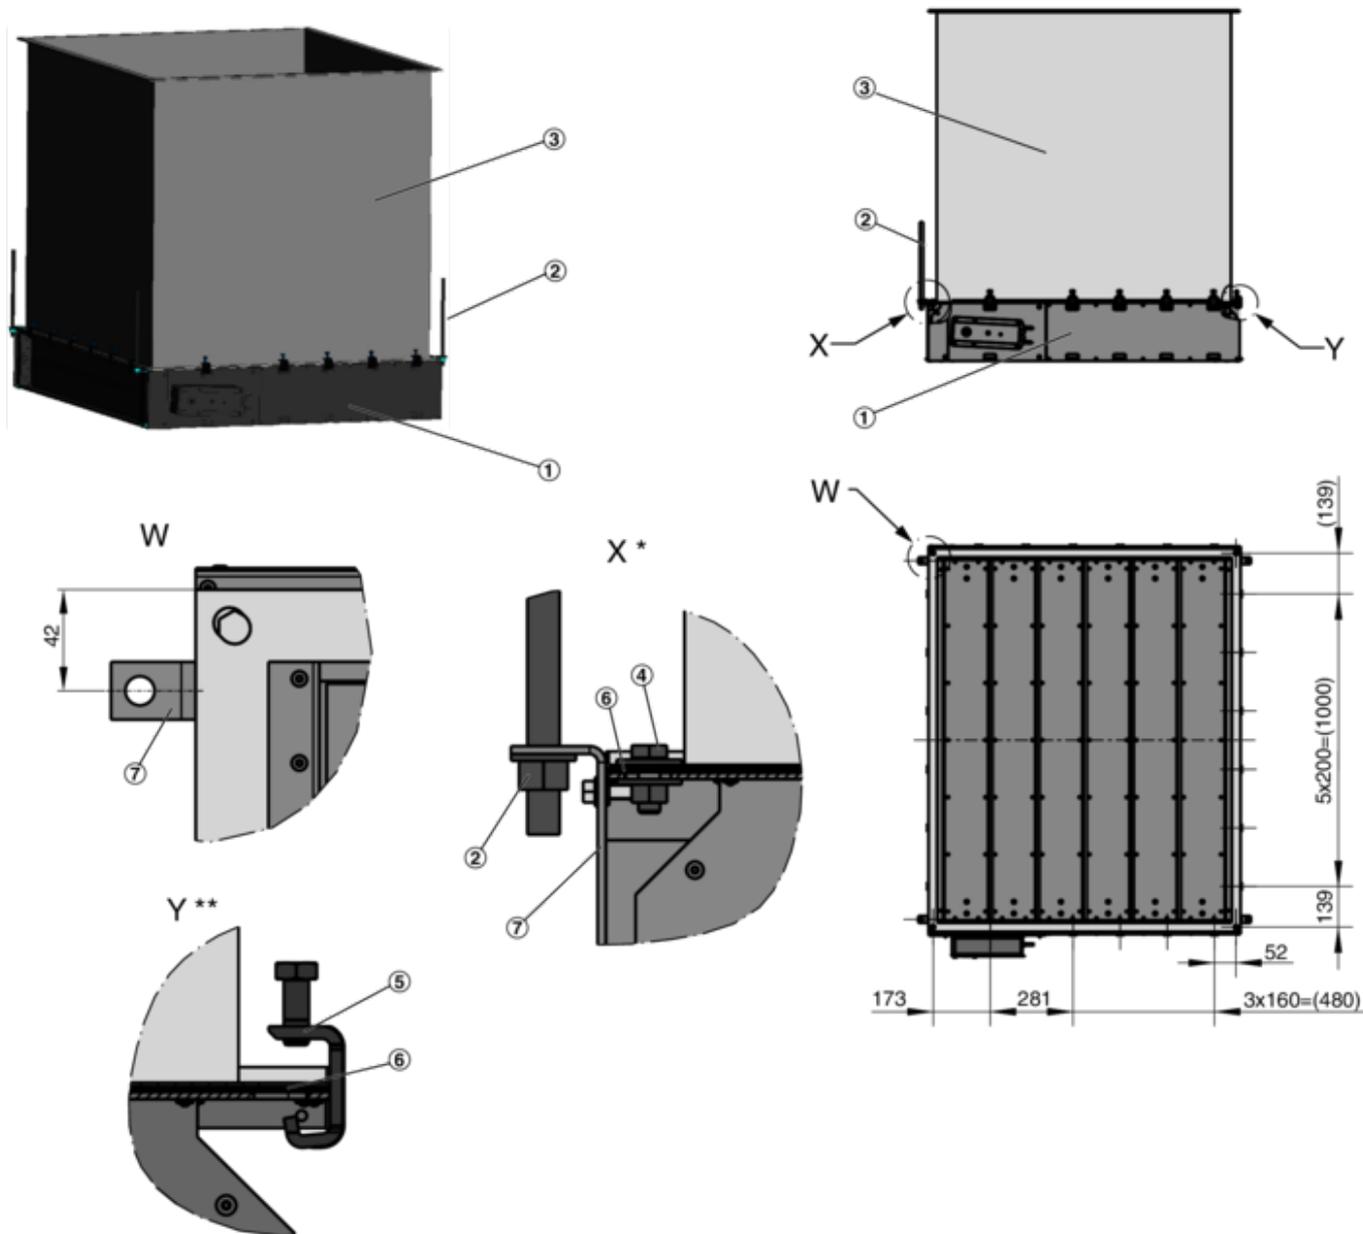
Einbau am Ende einer vertikalen Entrauchungsleitung
